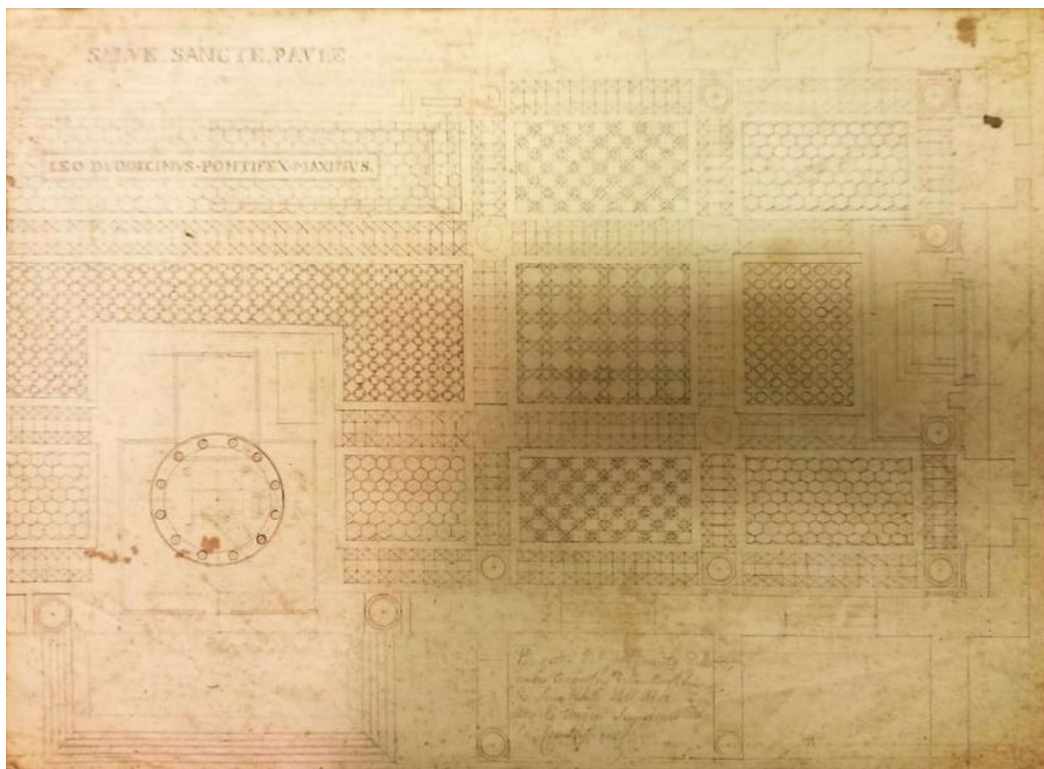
A. Uggeri, *Progetto per il pavimento dell'area presbiteriale della basilica di San Paolo fuori le mura*, 1827. Oltre al reimpiego di porzioni dell'antica pavimentazione cosmatesca si nota l'inserimento del tempietto a pianta circolare AMSP (courtesy of Michael Groblewski)
